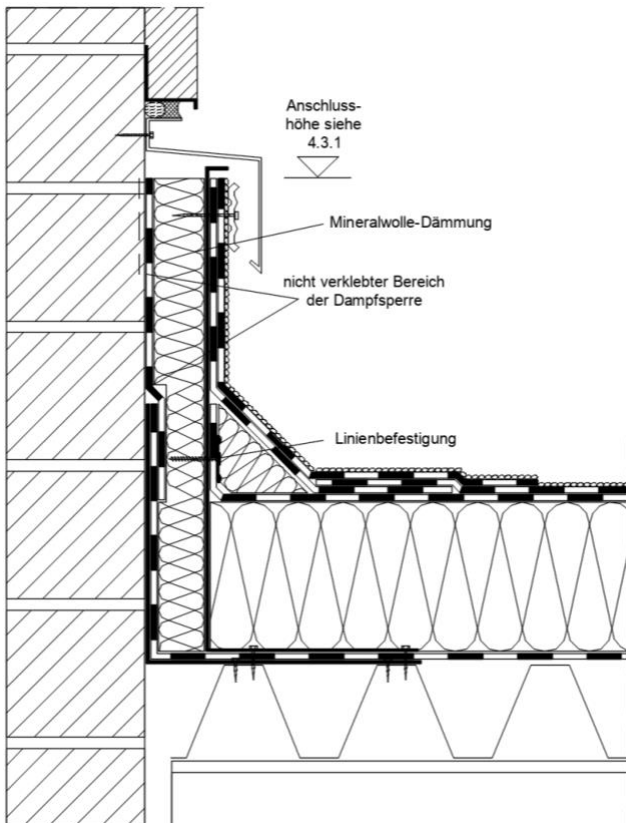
Beweglicher Wandanschluss mit Kunststoffbahnen – ungedämmte Wand
